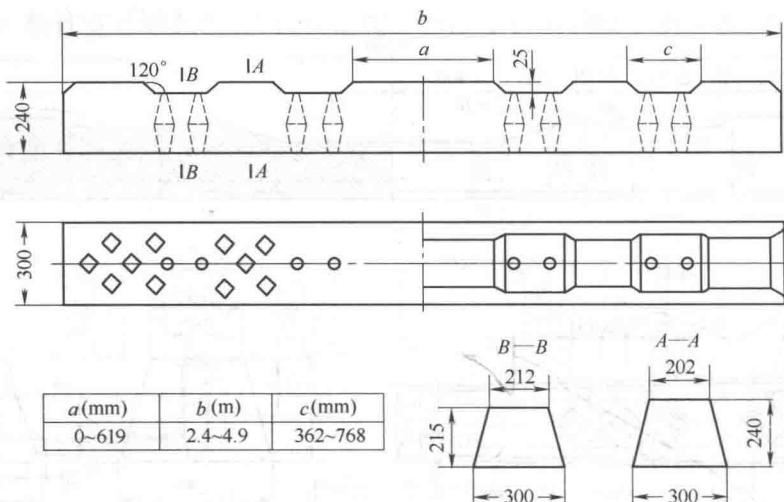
混凝土岔枕外形和截面尺寸(单位:mm)
